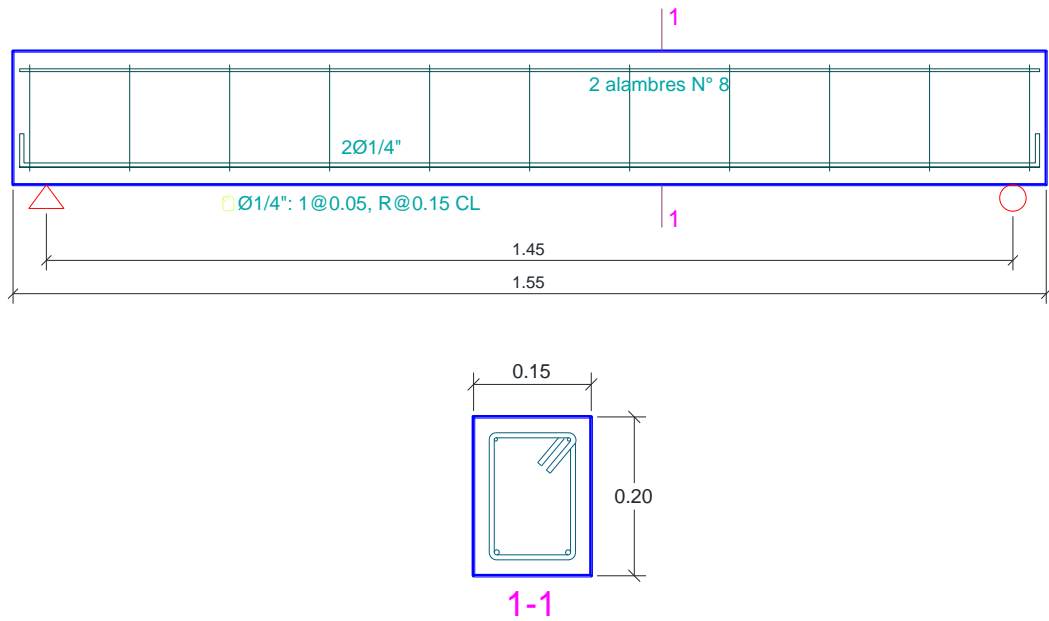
Esquema del refuerzo con acero corrugado interior colocado.
